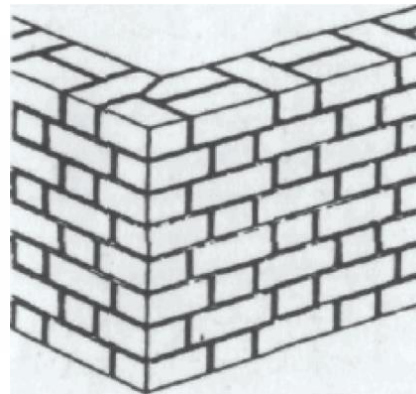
, Aturan Batu Memanjang Batu Menyilang Melintang Bersilang (staand)
